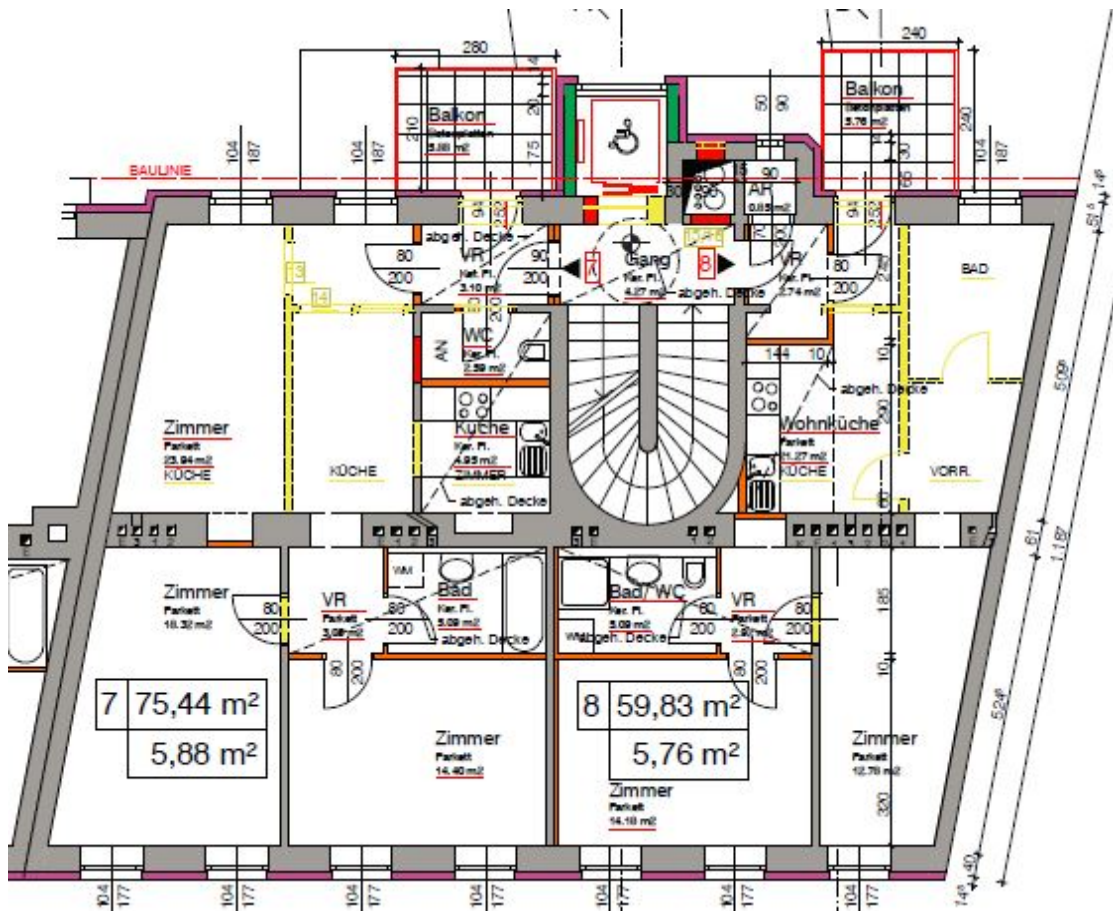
Davidgasse 23, Grundriss 3. Stock (Quelle: Auswechslungsplan 06.07.2010)
